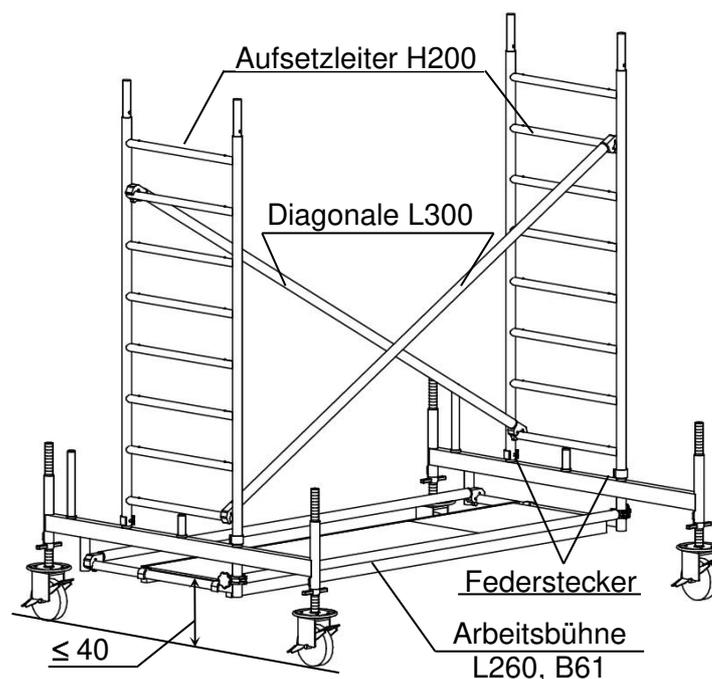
Grundeinheit mit Fahrbalken L180 – mittige Stellung
